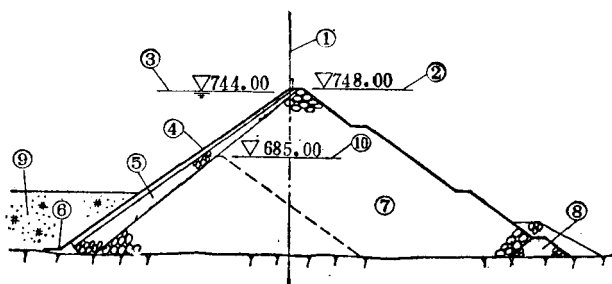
福兹多埃里阿混凝土面板堆石坝典型横剖面图
